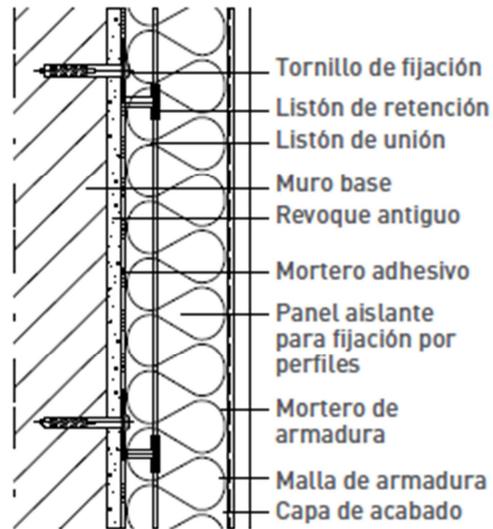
Sección constructiva fijación mecánica mediante perfiles.
